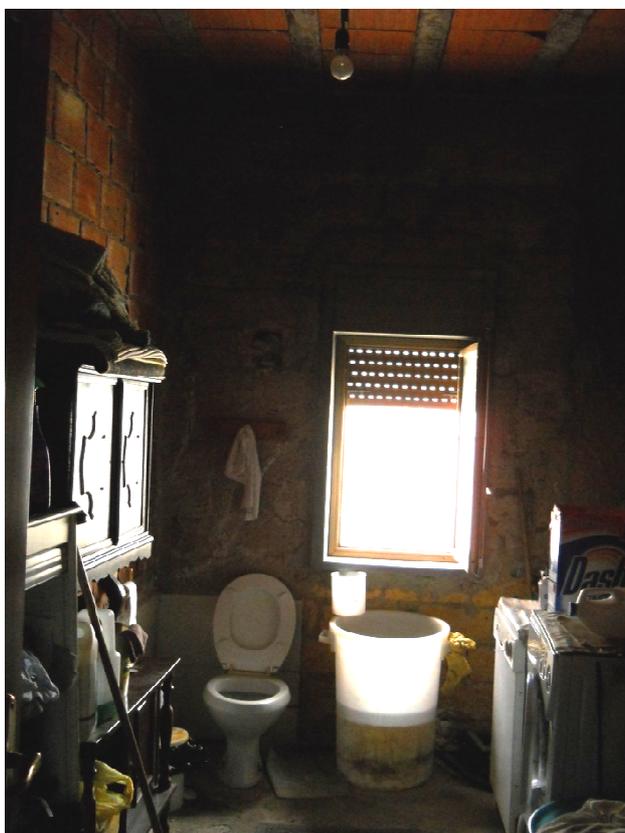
CORPO A – Porzione orientata verso Sud - Particolare della lavanderia
